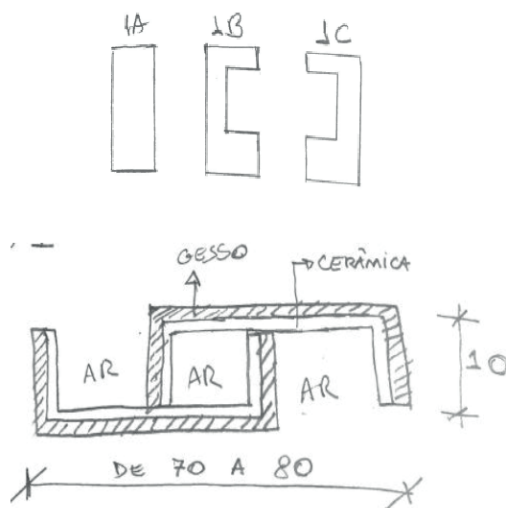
Croqui de peças pré-moldadas para fachada: elevações (1ª, 1B, e 1C) e planta. Acervo do Autor
